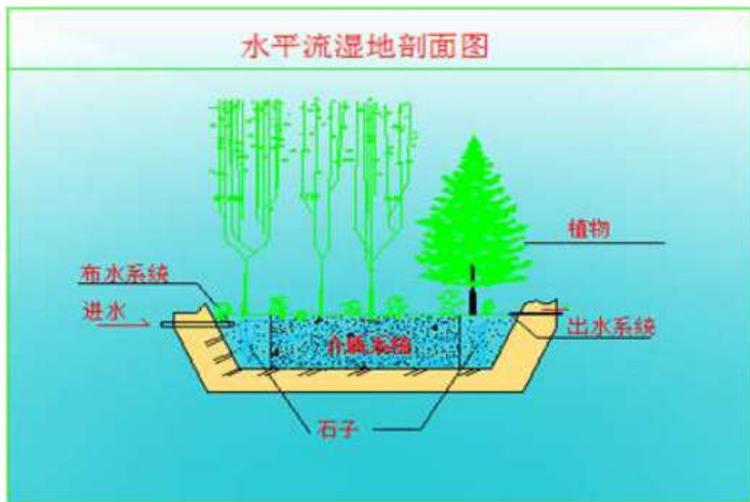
(1) 水平潜流人工湿地剖面图
